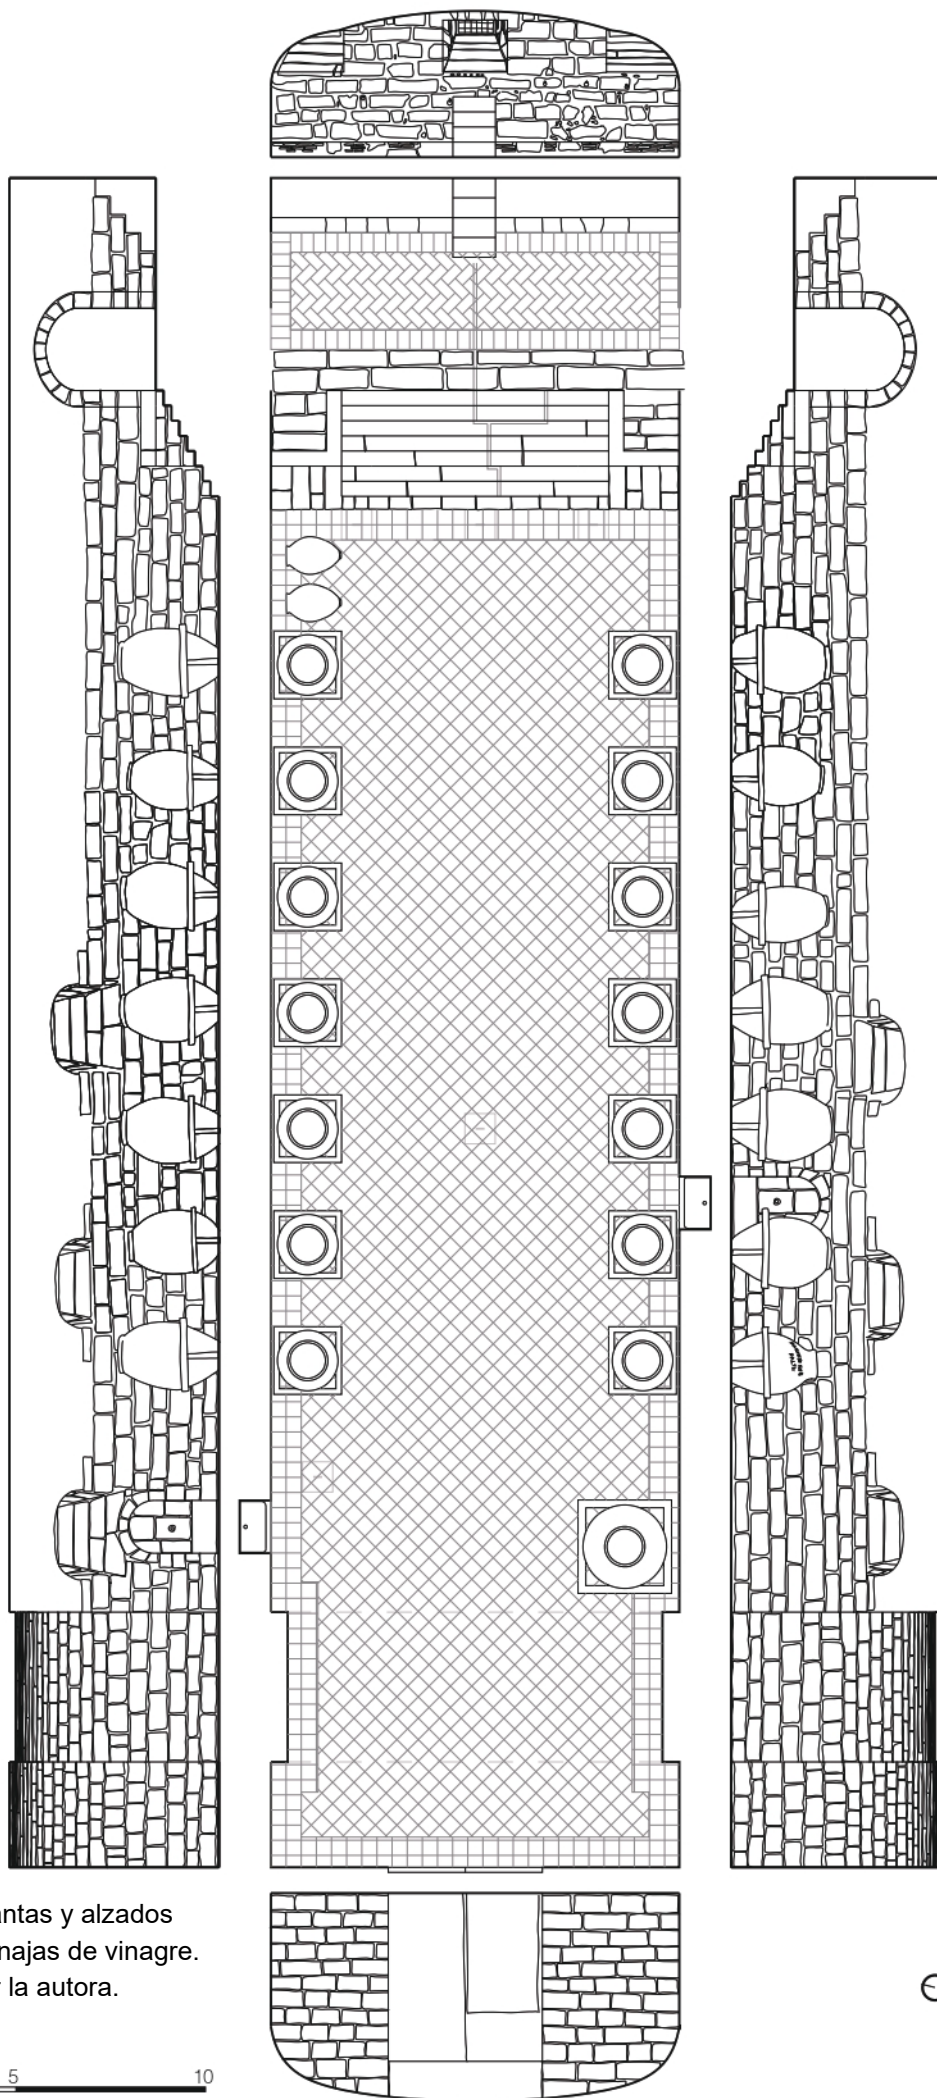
Plantas y alzados bodega con tinajas de vinagre. Realizado por la autora.
